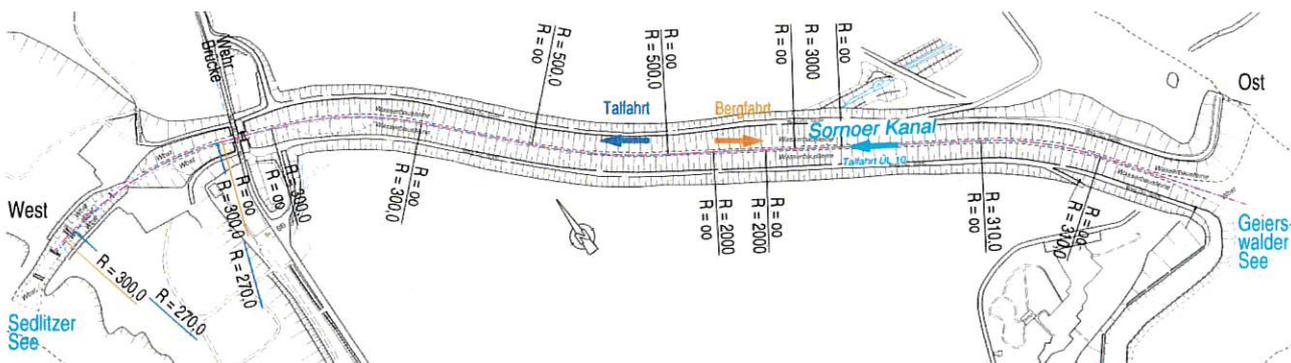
Lageplan Sornoer Kanal (ÜL 10) [3]
